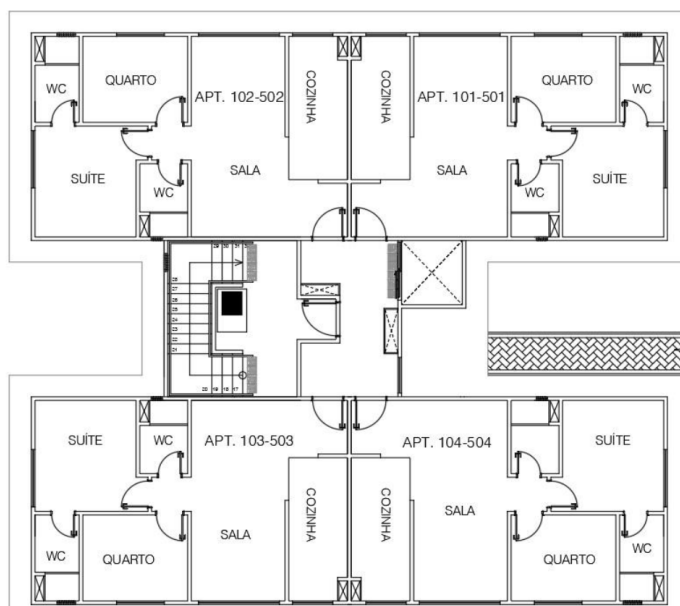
Planta baixa do pavimento tipo da edificação C (AUTOR, 2023).
